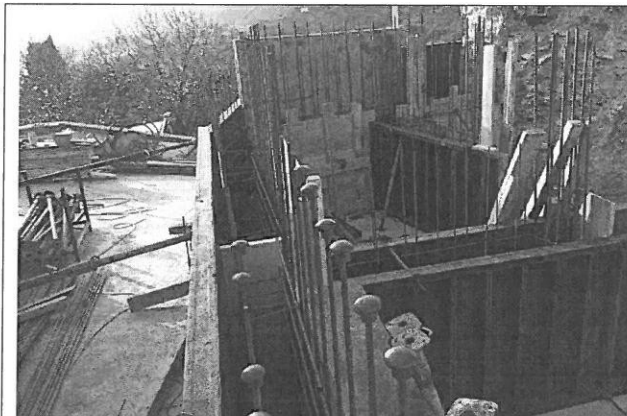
Se comienza con el encofrado de la base de los muros. Y su armado
